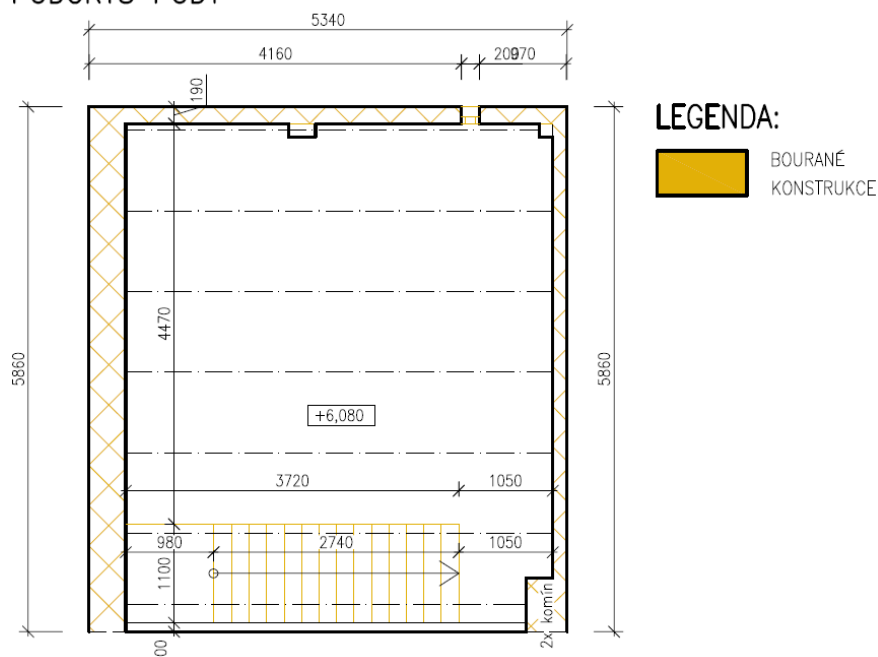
Půdorys budoucích bouraných stěn objektu
